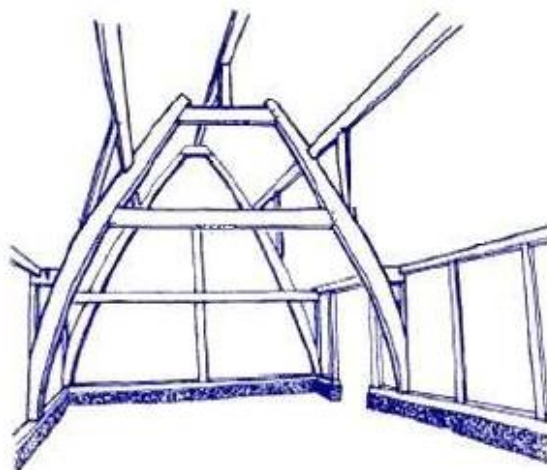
Estrutura tipo de uma construção de estrutura A (*cruck frame*)
